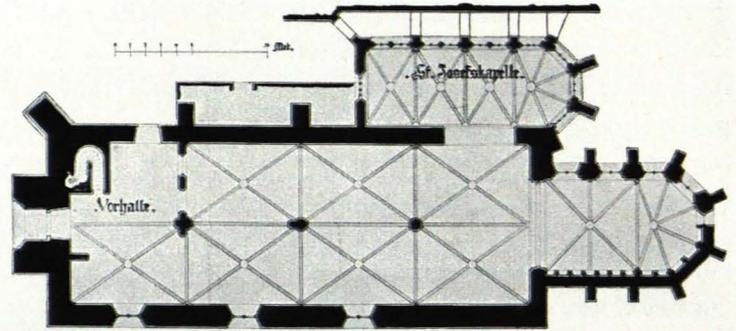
Imbach, Pfarrkirche, Grundriß 1 : 500 (S. 189)
